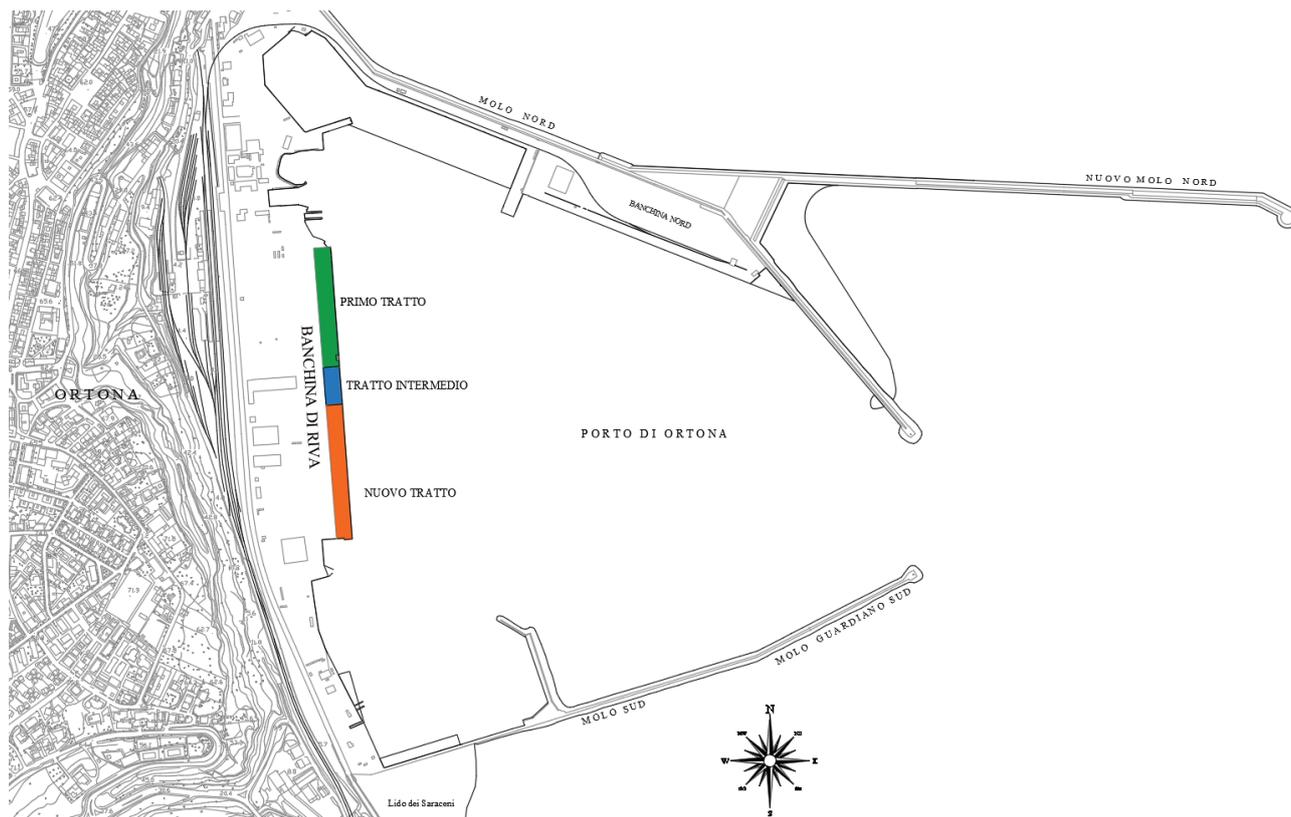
Planimetria Banchina di Riva del Porto di Ortona
